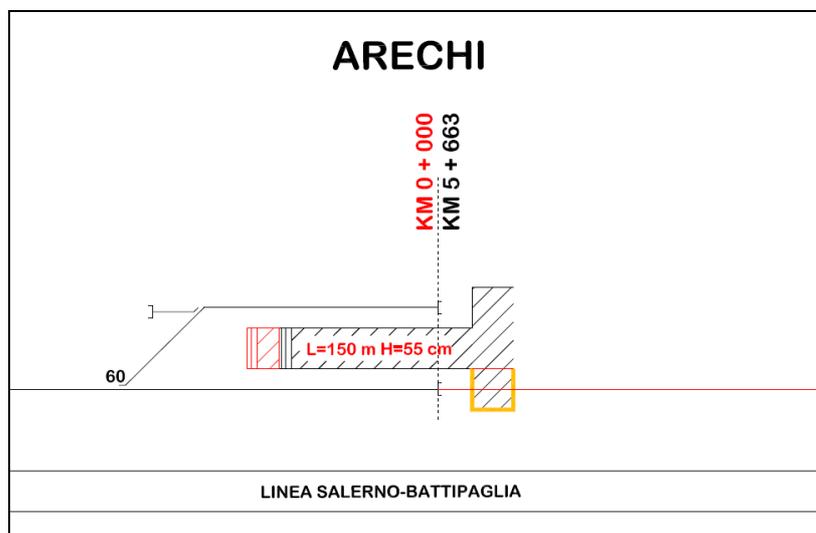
Schema funzionale di progetto – Fermata M8 Arechi
